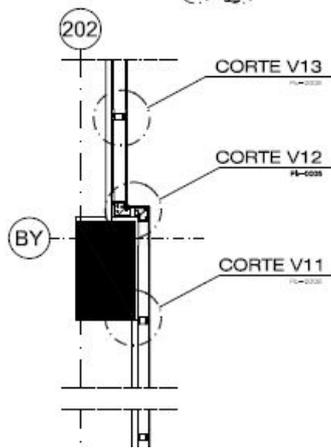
Módulo unitizado localizado nos cantos - Planta baixa
